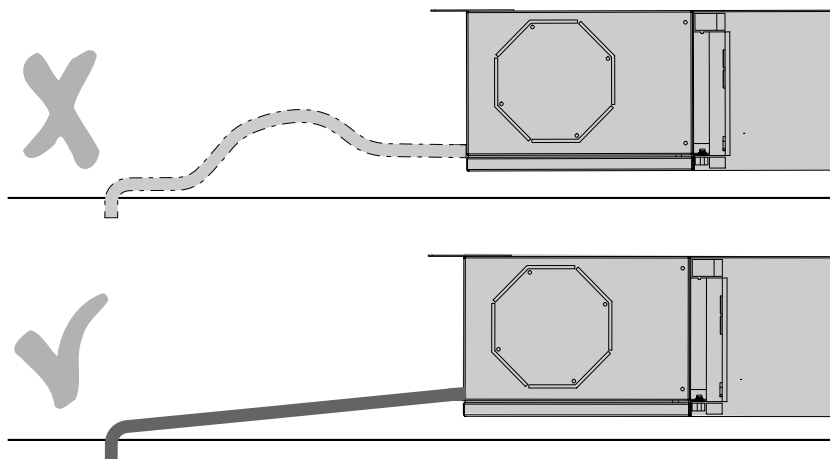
Instalación correcta de la manguera de drenaje con una pendiente constante, incorrecta en la parte superior, correcta en la parte inferior.
